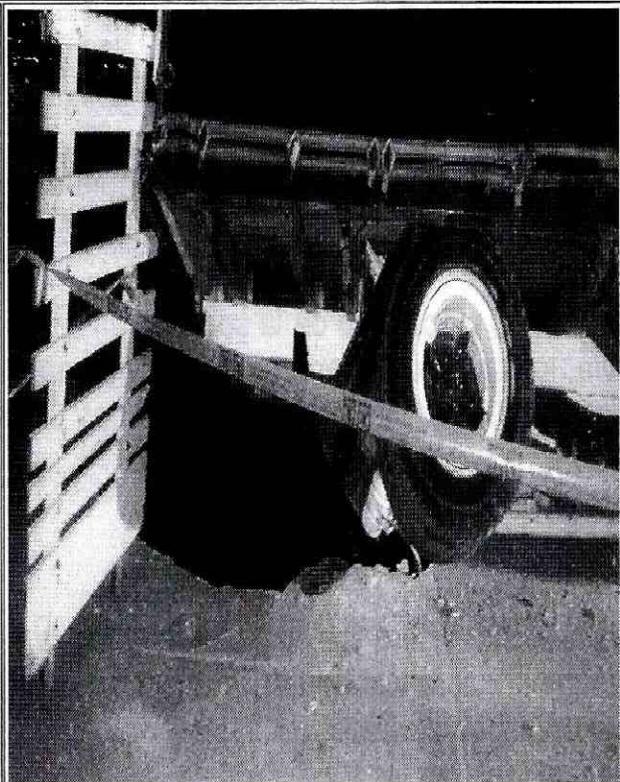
Colapso de la losas de concreto por socavación de la cimentación de la vía (19/08/2016)
